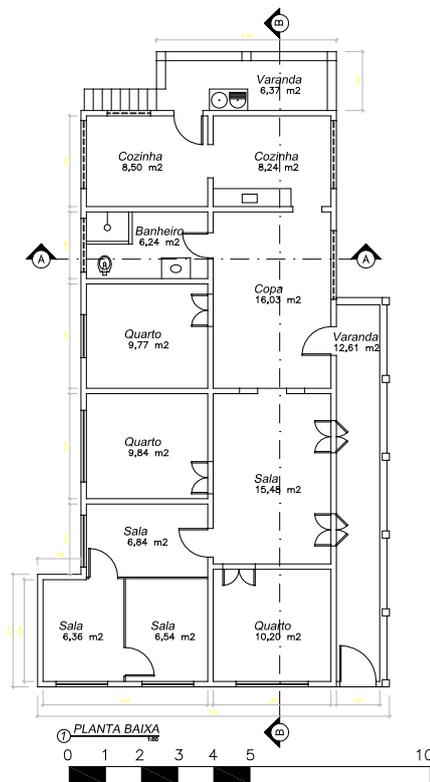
Planta pavimento térreo - Casa Fabiana Carmanhanes
